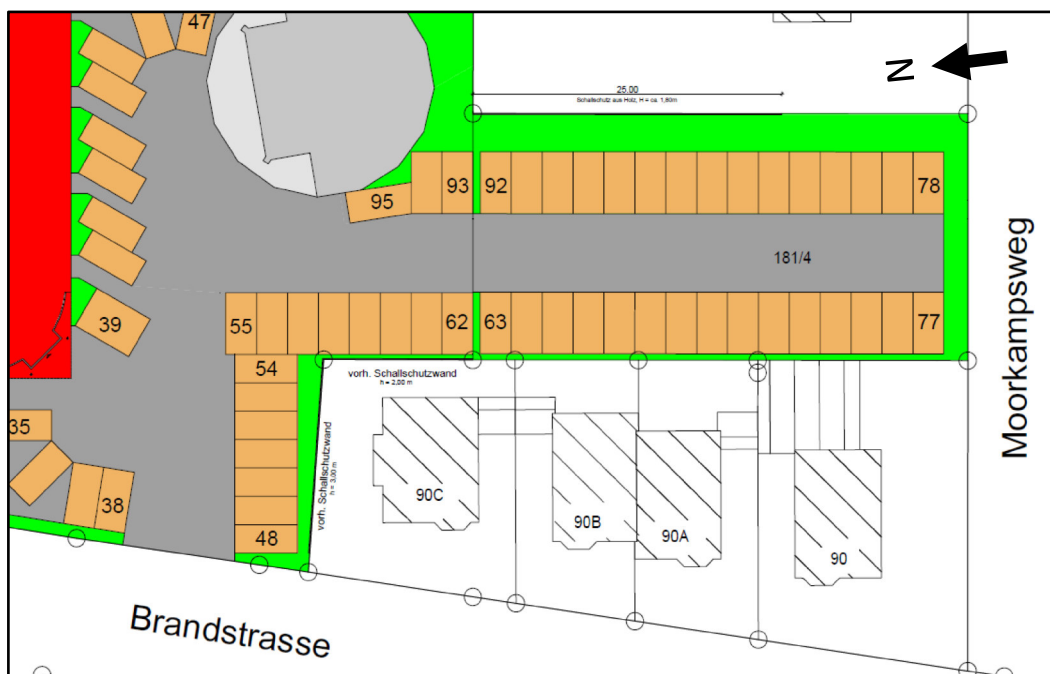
Lageplan des neuen Parkplatzes (Stellplätze 63 bis 92) und der bestehenden Lärmschutzwände [12]
